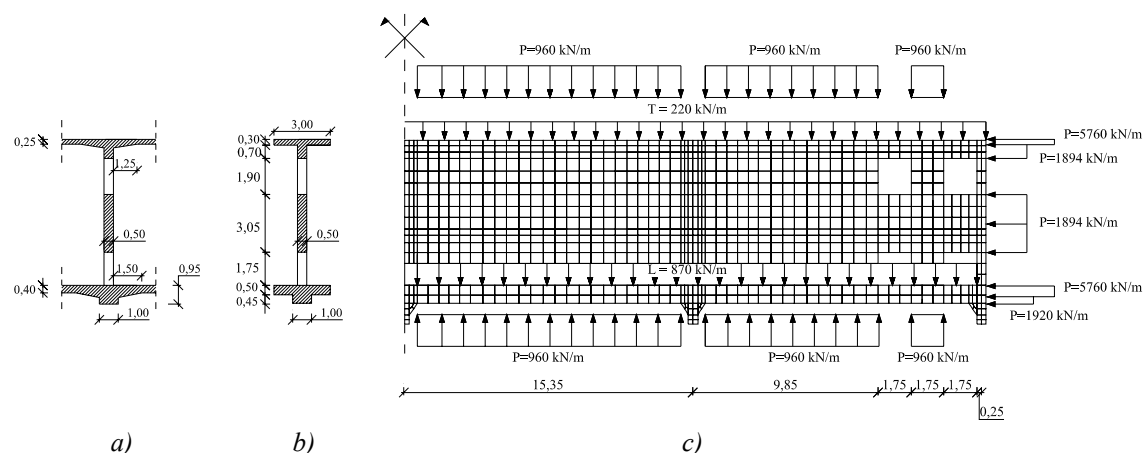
Análise bidimensional das vigas-parede com aberturas: a) Corte transversal; b) Modelação das espessuras; c) Malha de elementos finitos com o esquema das cargas aplicadas (L – peso do líquido e da laje de fundo, T – peso das terras e da laje de cobertura; P – carga equivalente ao pré-esforço).
